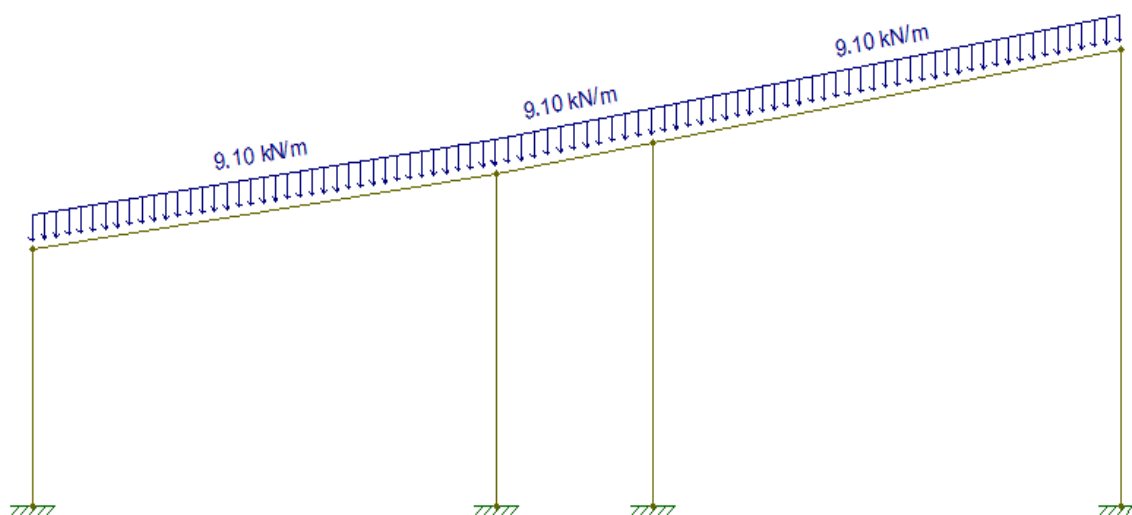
Esquema de carregamento do pórtico mais solicitado - LABRADS.
